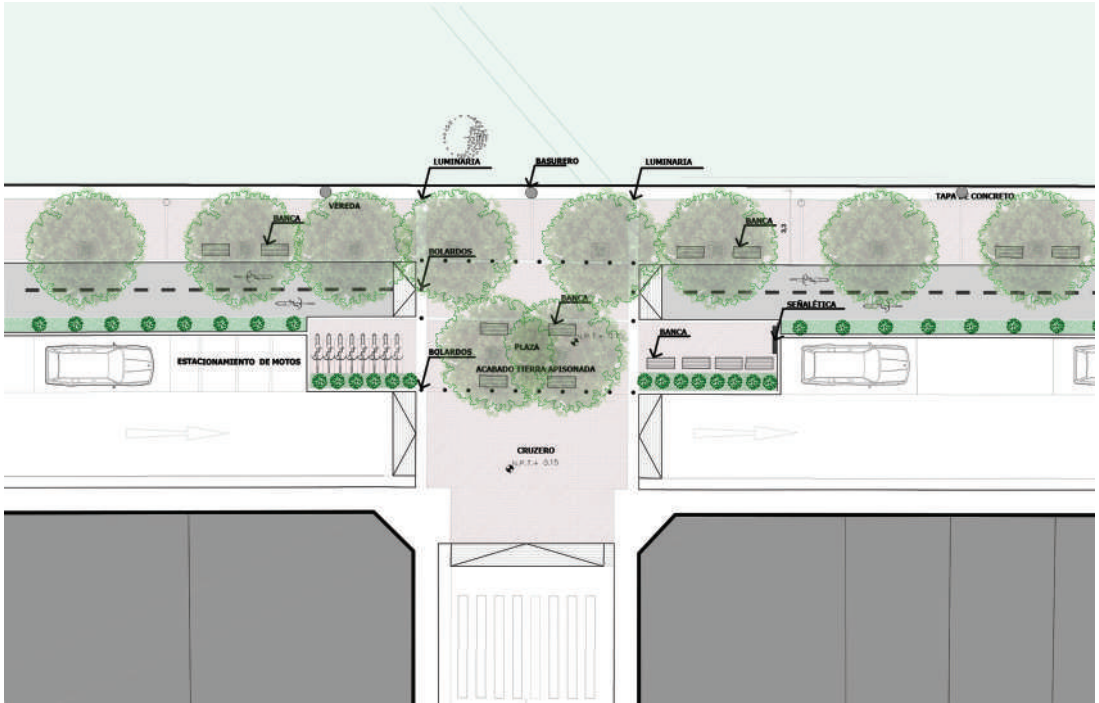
Detalle en plazas propuestas para intersección de calles. Elaboración propia. Archivo proyecto Transversal, 2014.
